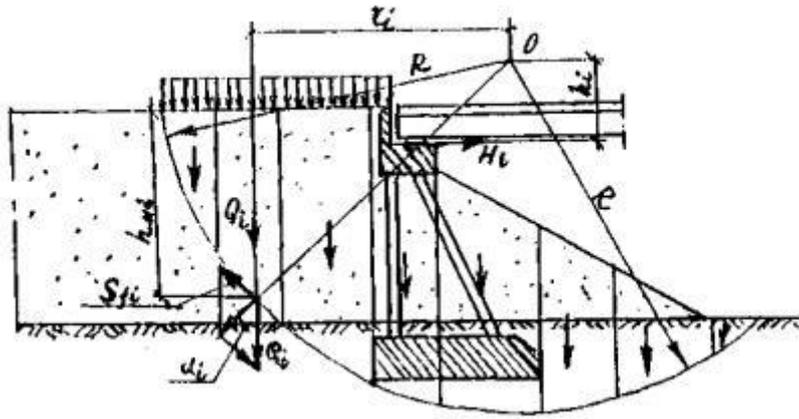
Схема к расчету опоры на глубокий сдвиг
